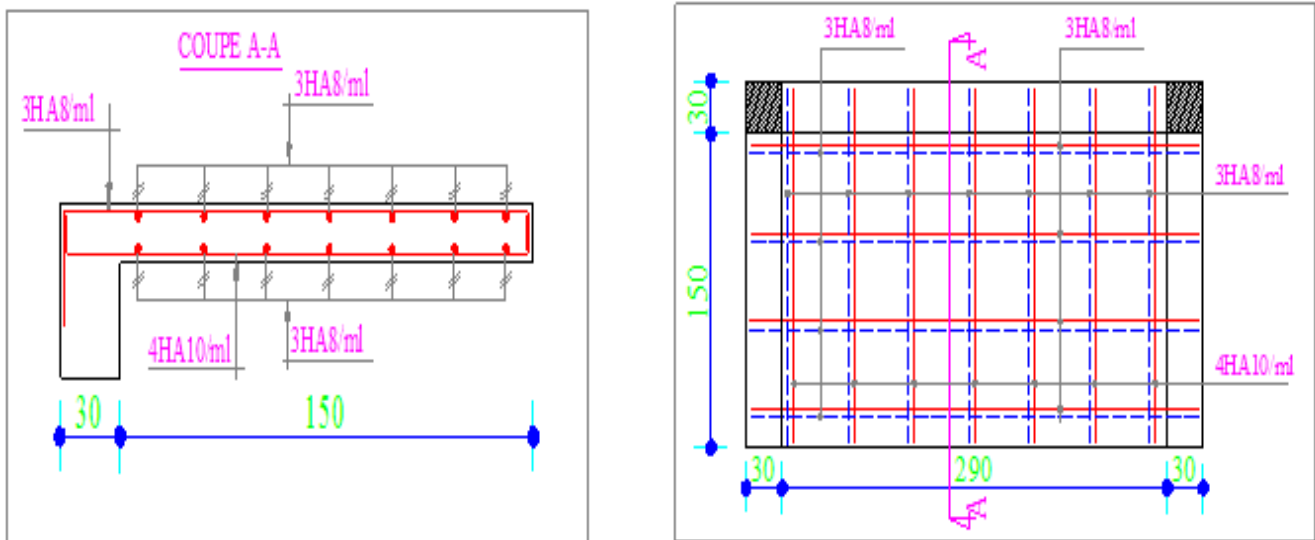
Schéma de ferrailage de la dalle sur trois appuis
